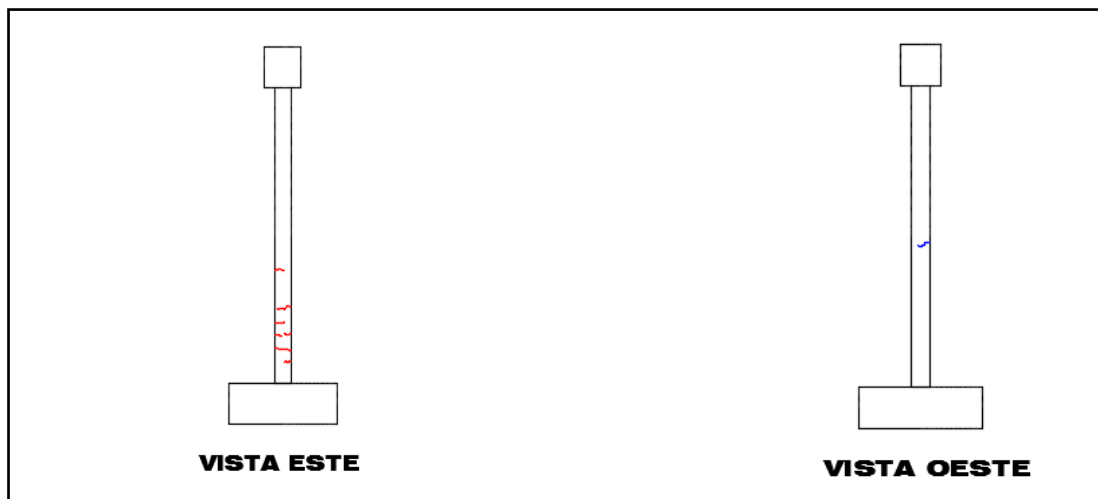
Mapeo de fisuras de elementos de confinamiento para una distorsión de 1/1500.
